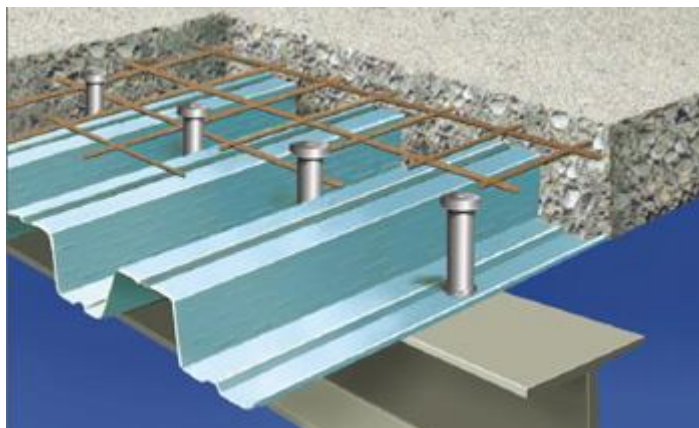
Laje *steel deck*: Fonte: Metform
